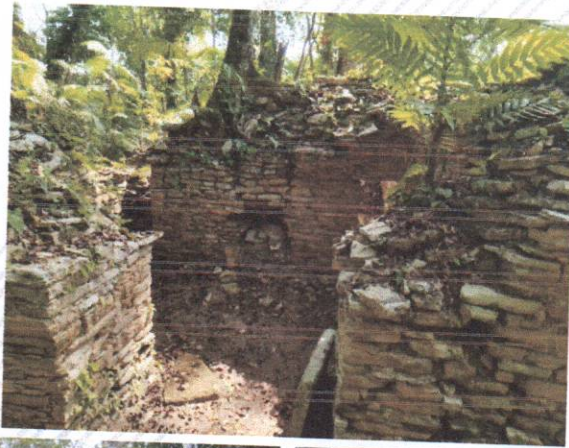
Estructuras restauradas en peligro de colapso, Sitio San Clemente. Arriba, amenaza de árbol; izq. Estructura colapsada; derecha, Techo colapsado.
